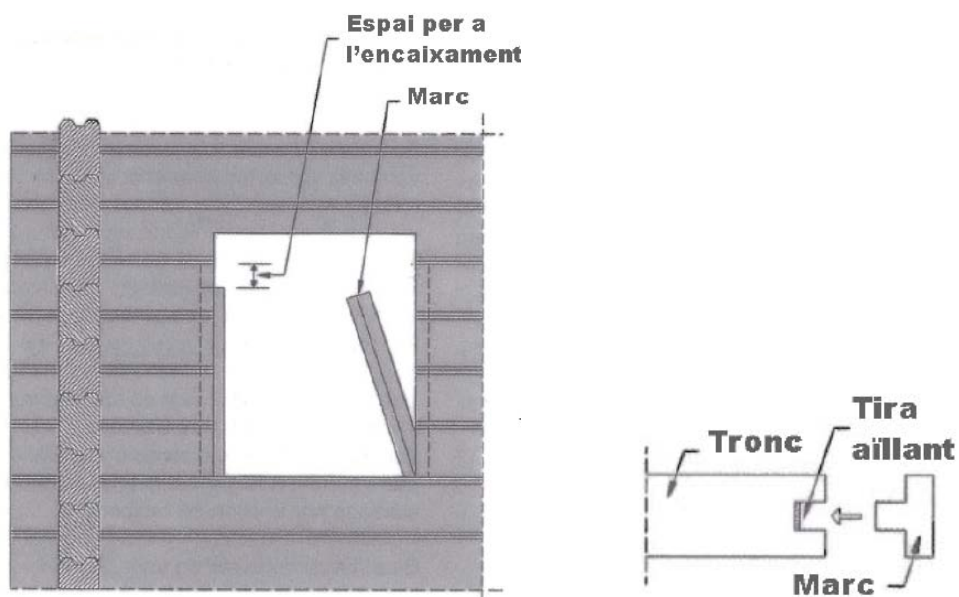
Detall de construcció d'obertura en el mur de troncs de fusta [23].
